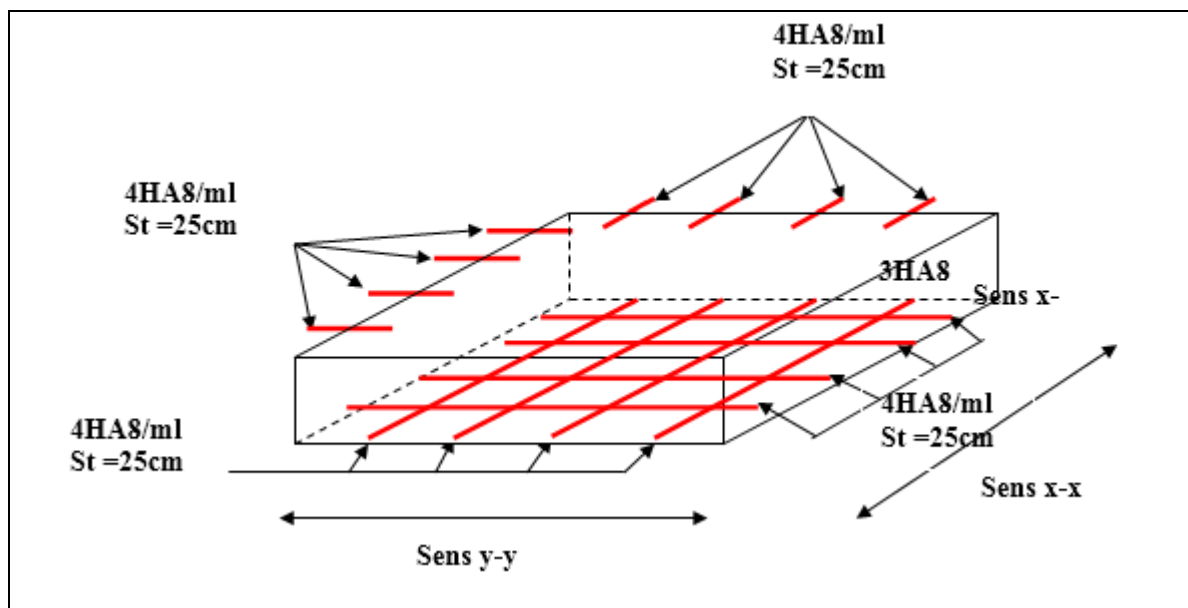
Schéma de ferrailage de la dalle pleine au-dessous de l'ascenseur.
